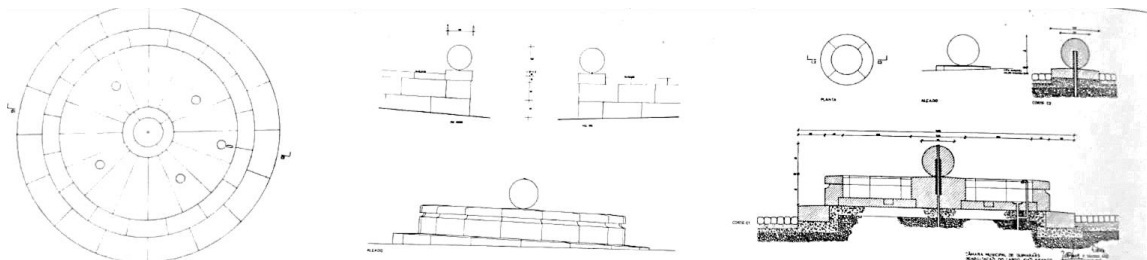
Planta, Alçado e Corte da fonte na Praça João Franco. Fonte: (Trigueiros, 1993).
